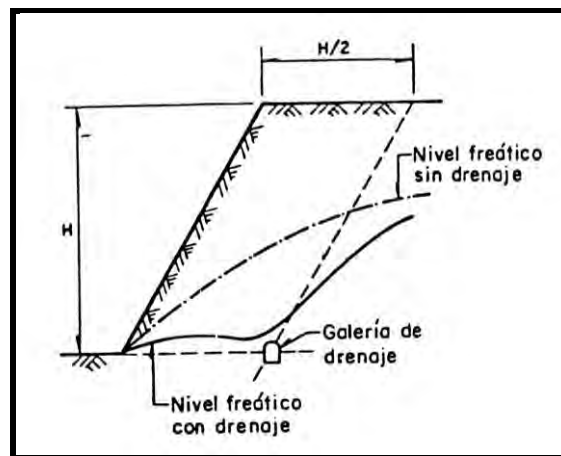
Emplazamiento de una galería de drenaje bajo un talud.
